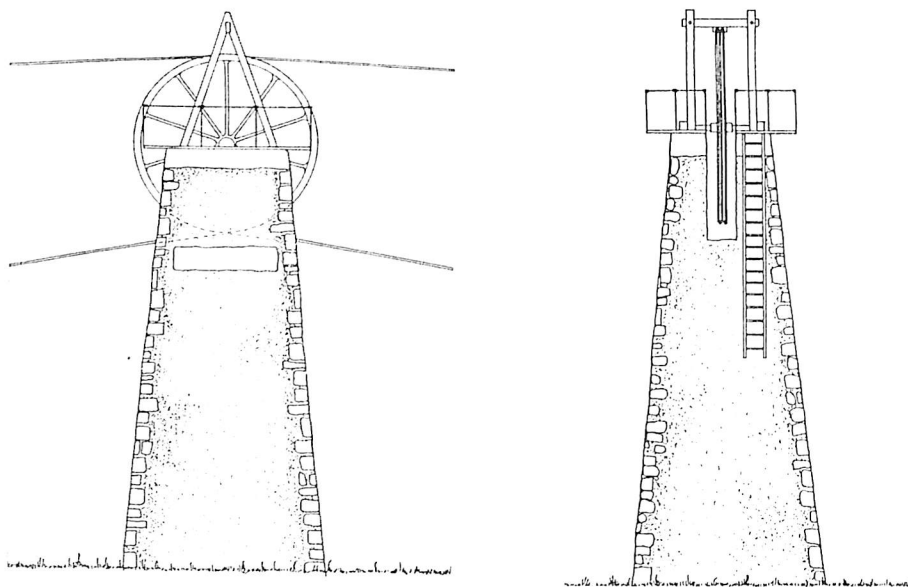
Prospetti di un pilastro intermedio per il sostegno della ruota di trasmissione con diametro di 4,05 m. I pilastri avevano un'altezza di 9,5 m per la parte in muratura, di 12 m con il castelletto di legno.
